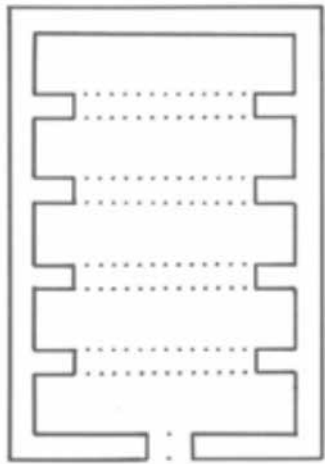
Planta hipotètica de l'església de la Sang de l'Hospital d'Inca
